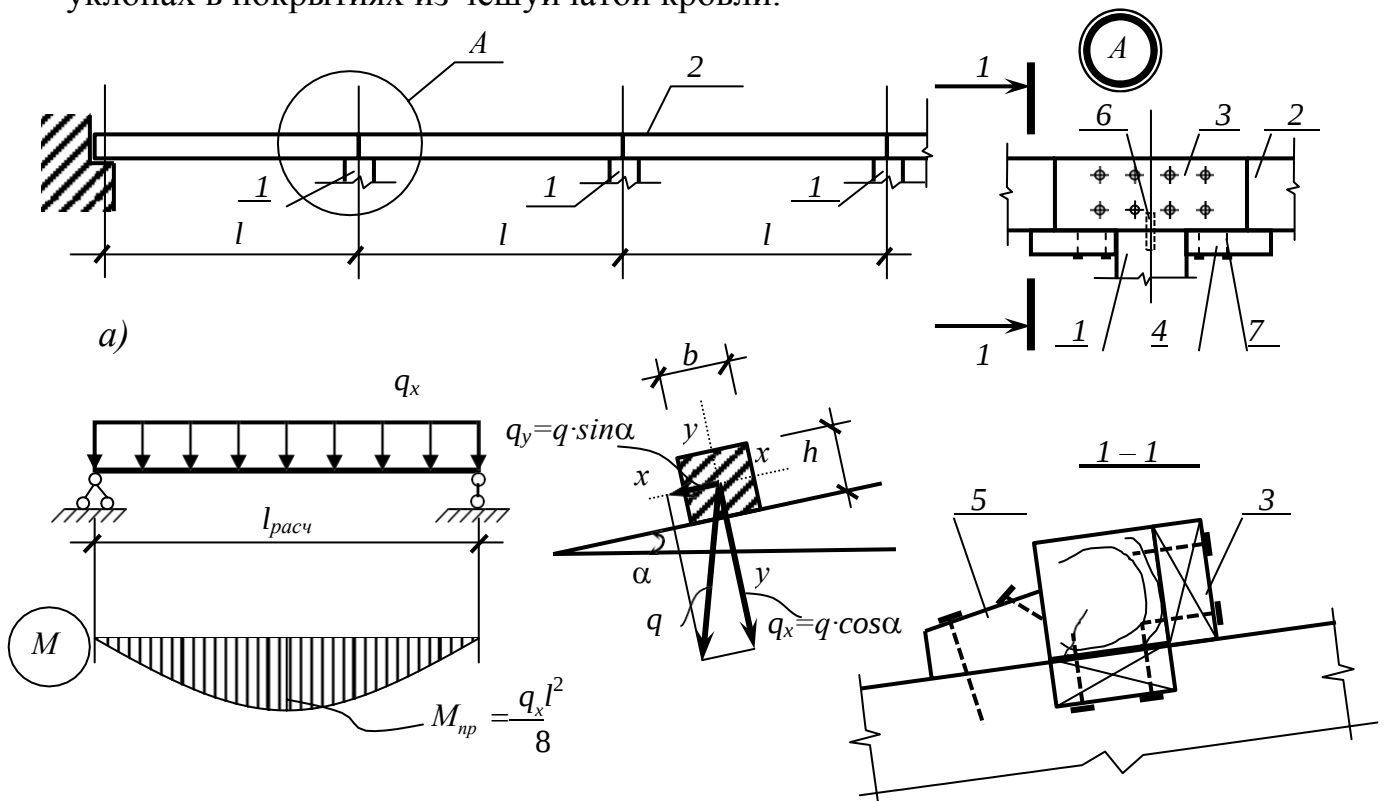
Схема разрезного прогона: а – расчетная схема. 1 – несущая конструкция; 2 – прогон; 3 – накладка на стыке прогонов; 4 – упорные кобылки из досок; 5 – бобышка; 6 – стальной стержень; 7 – гвозди
